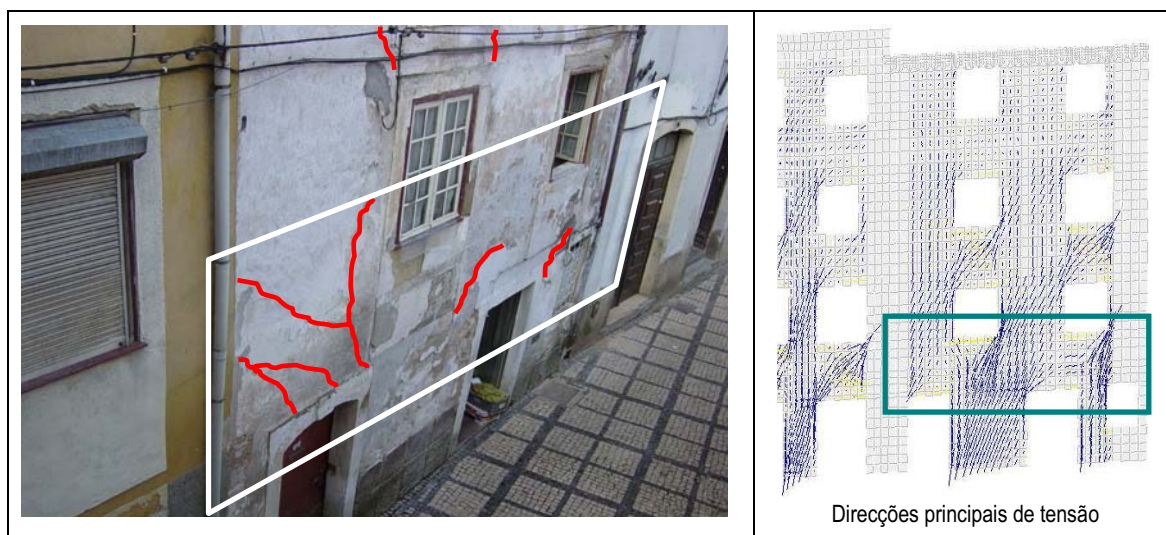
Fissuração observada e distribuição das tensões principais para cargas verticais
